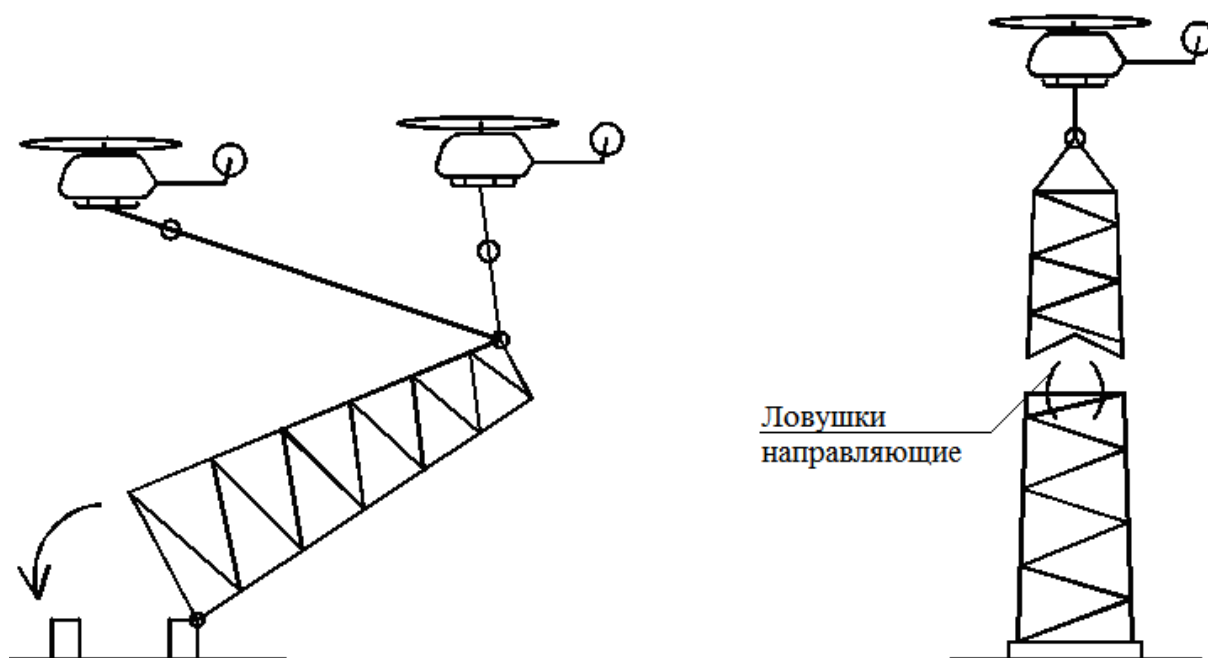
Поворот двумя вертолѐтами и безвыверочный монтаж
